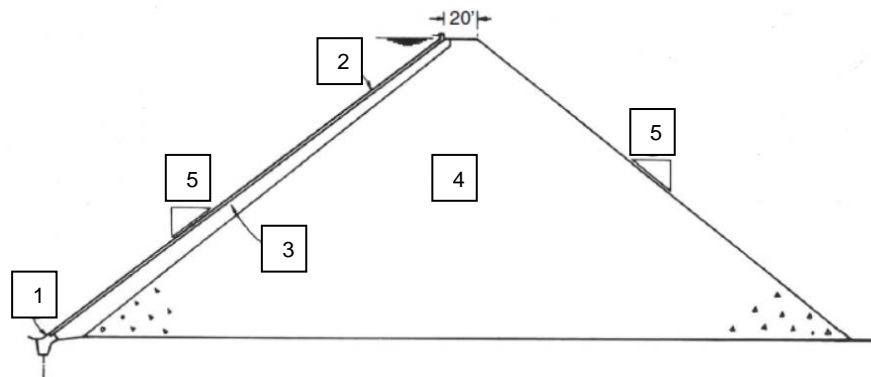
Características de diseño de las primeras presas de enrocado con cara de concreto (CFRD). (1) Trinchera de corte, (2) Losa de Concreto, (3) Roca grande colocada con grúa, (4) Enrocado descargado, (5) Talud. (Modificado de Fell et. al, 2015)
